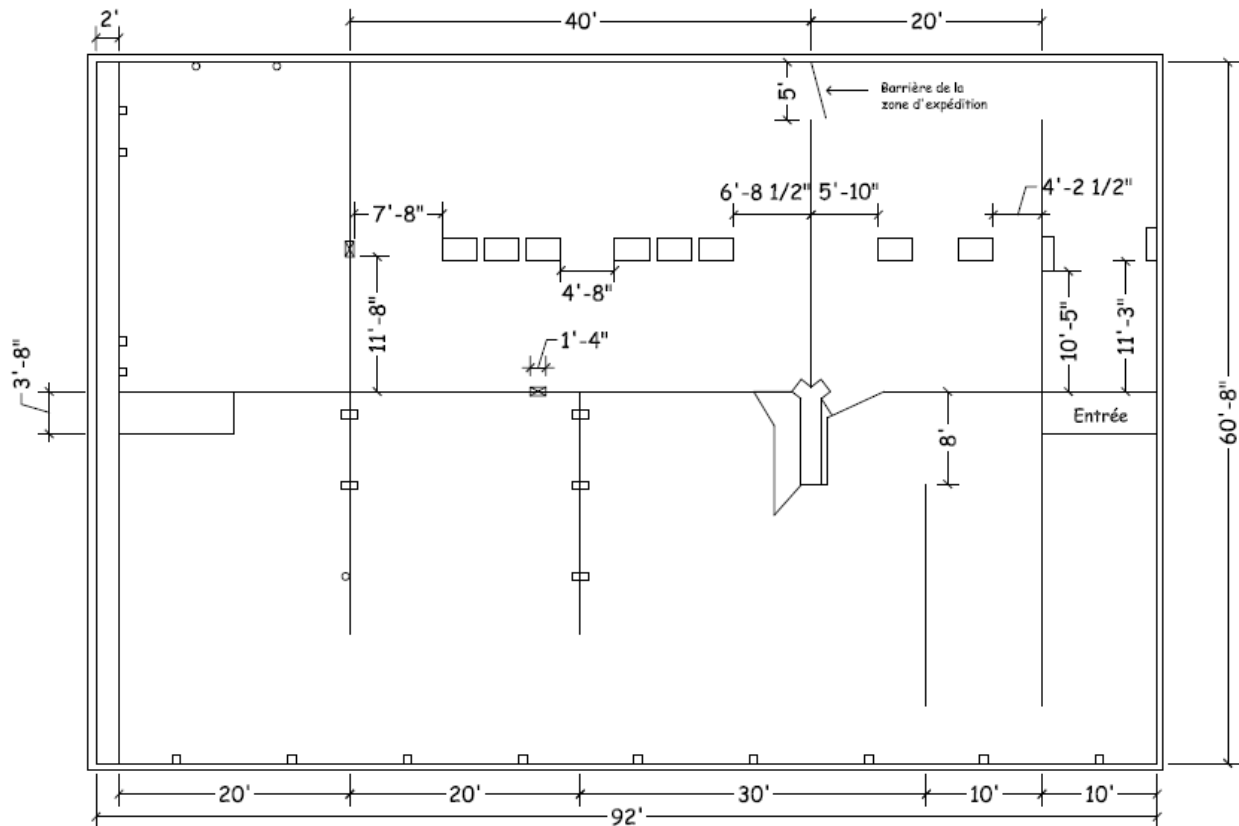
Plan de la salle B aménagée en cafétéria transversale (CT)
